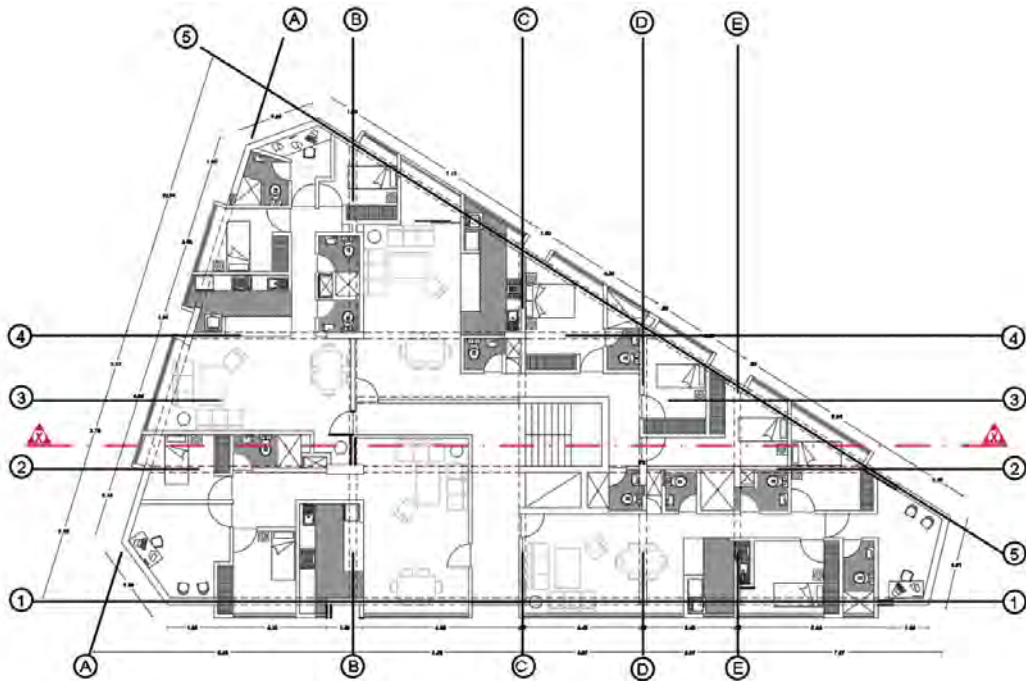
Planta de arquitectura piso típico (segundo al décimo nivel)
